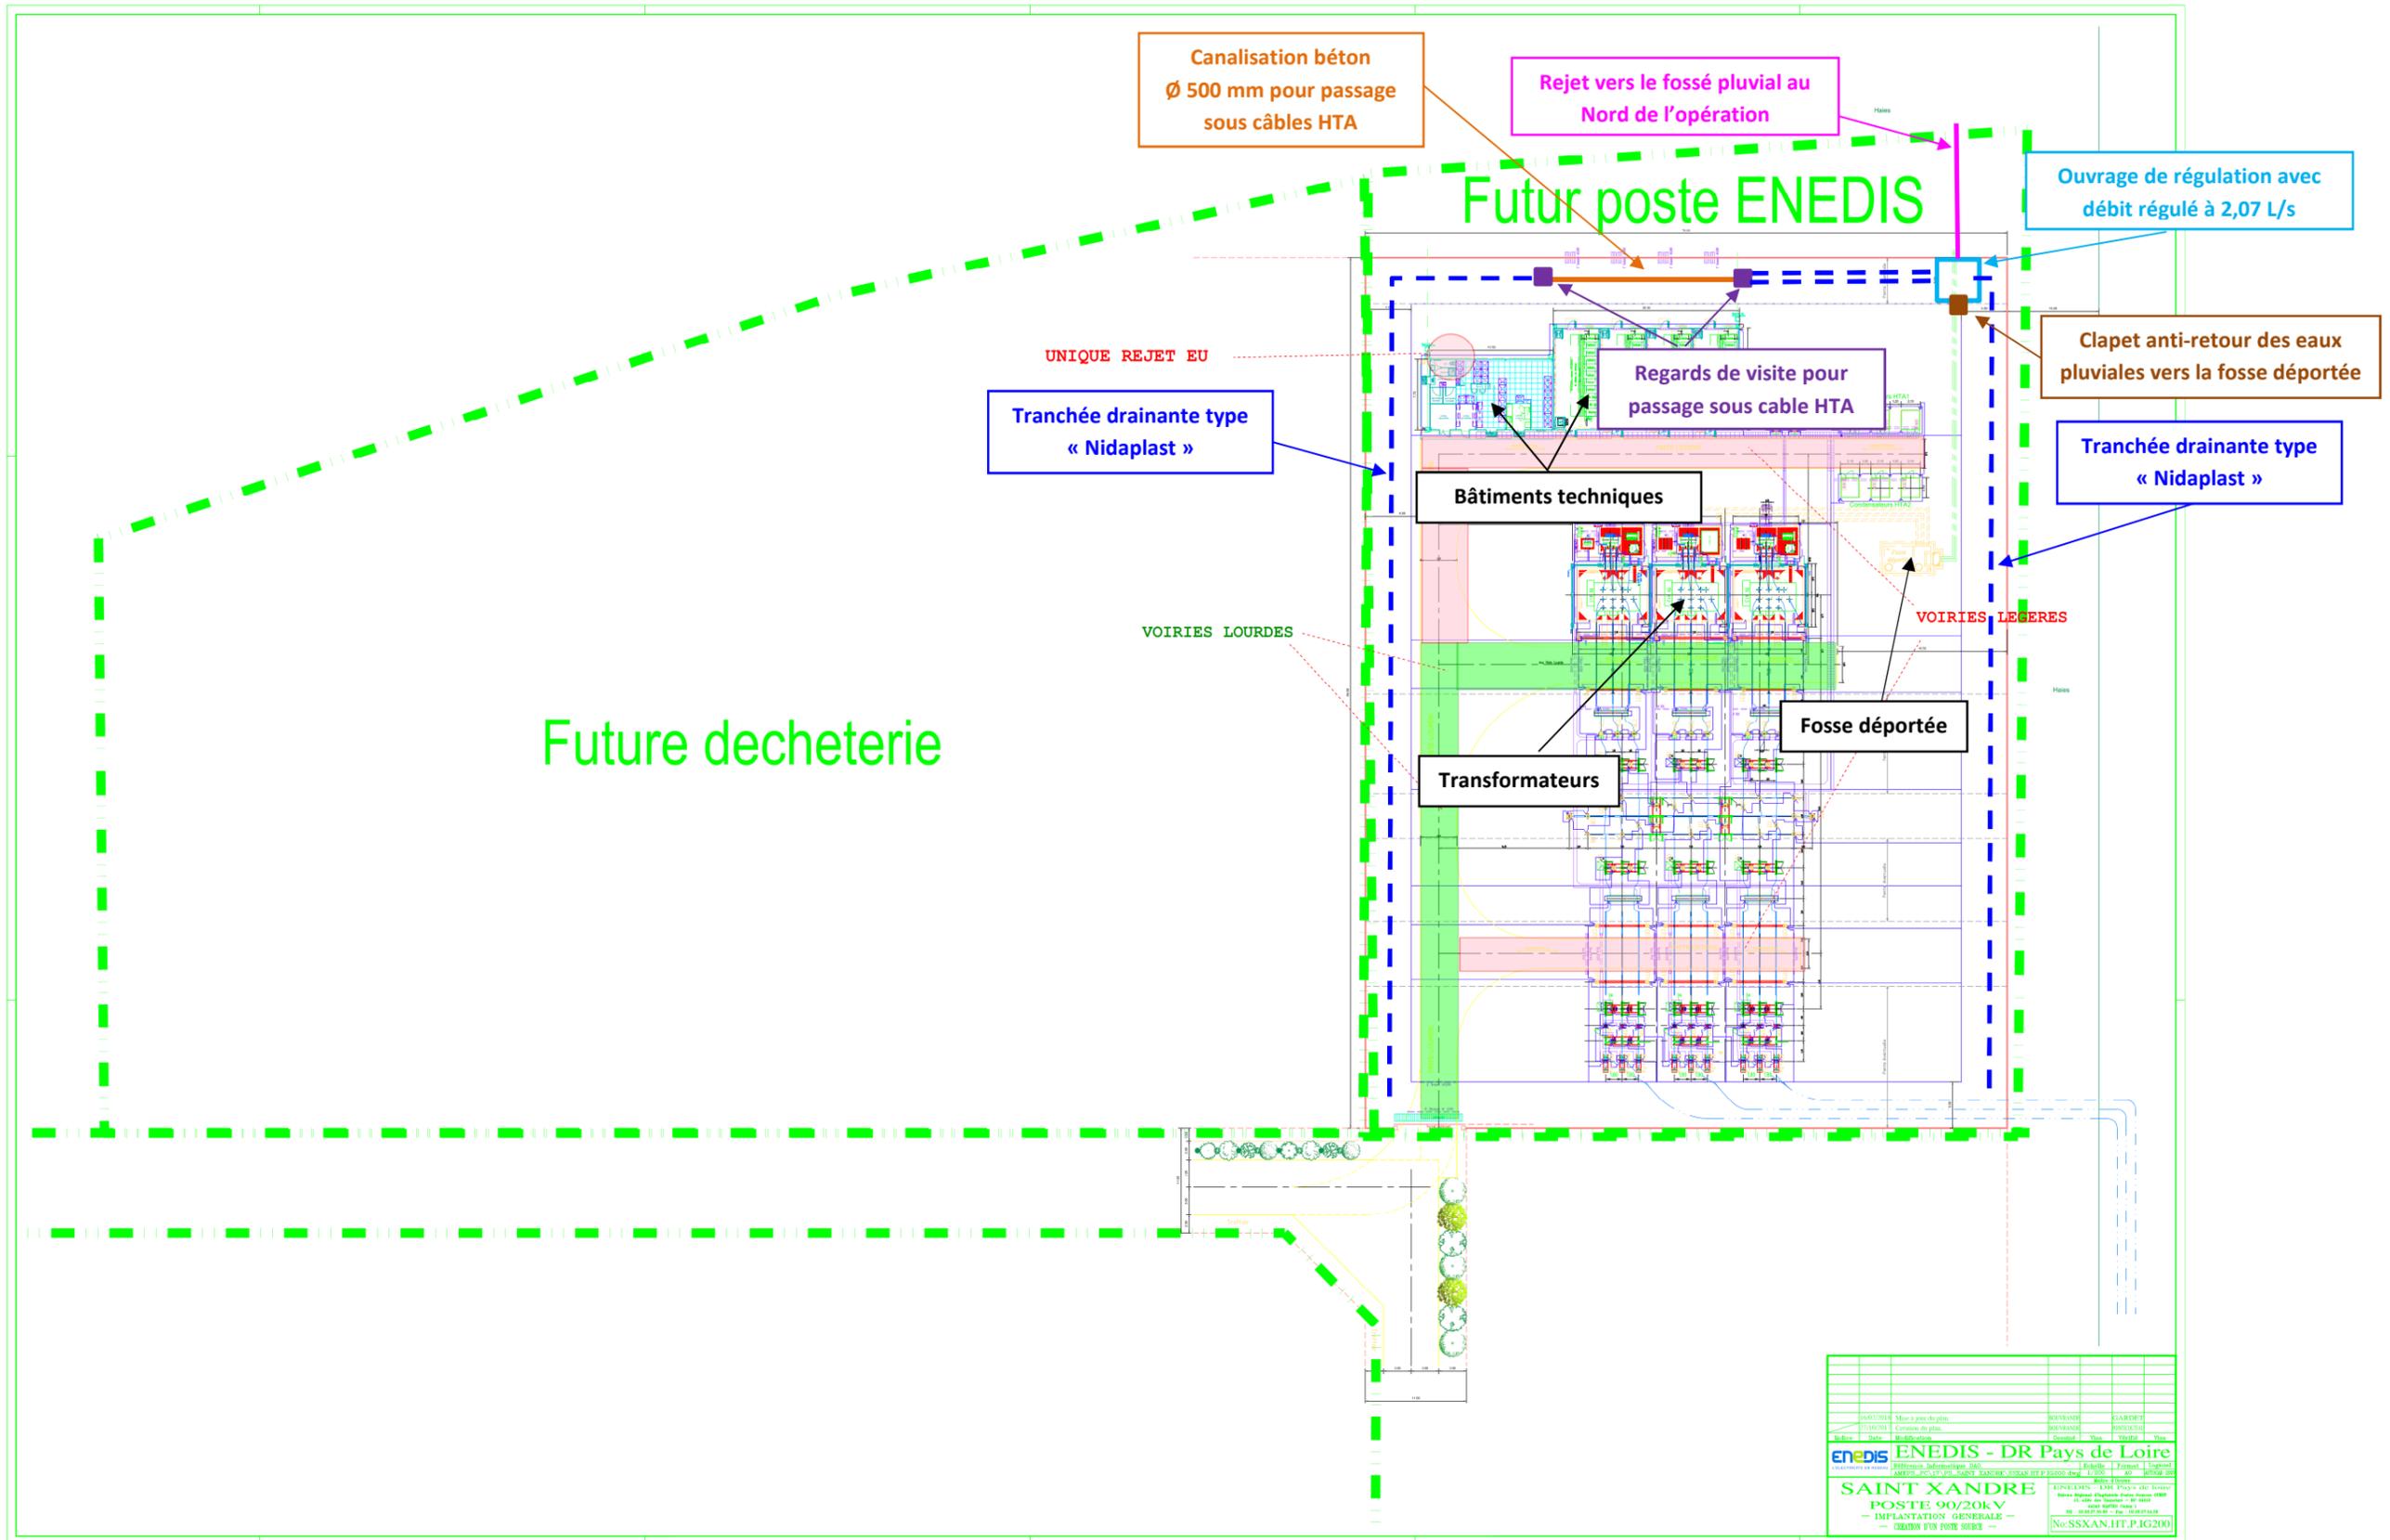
Plan d'implantation des dispositifs de gestion des eaux pluviales
